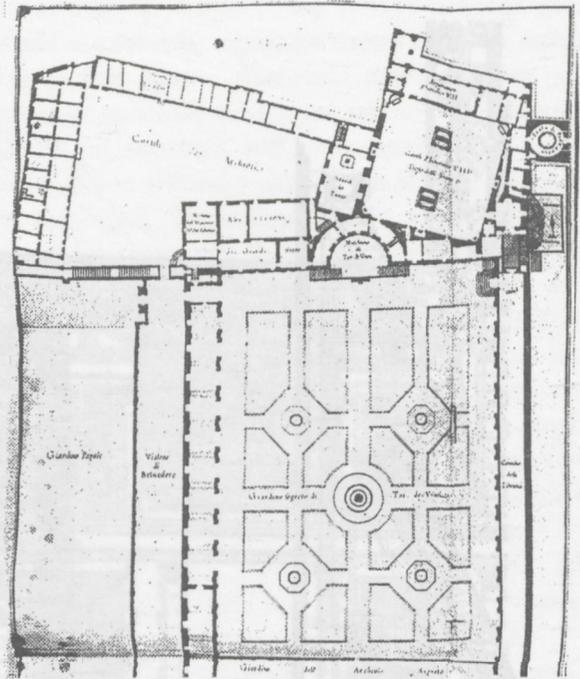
Zeichner des frühen 18. Jahrhunderts, Grundriß des Nordflügels des Cortile della Pigna
